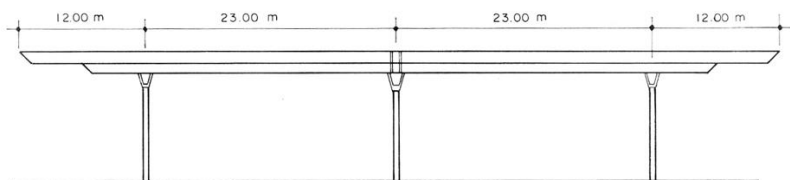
TRRM - Esquema da elevação do conjunto estrutural. [Fonte: Hanai, 1992]
